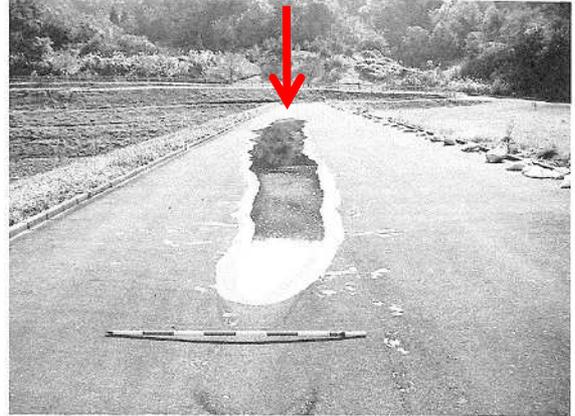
堤体天端の窪みとH形鋼突出 (新山本調整池)
